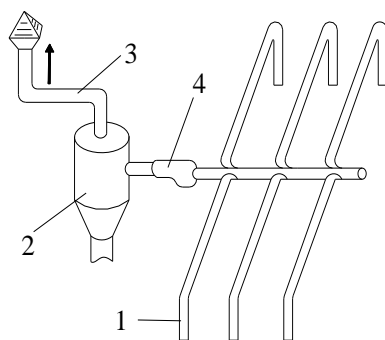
Принципова схема витяжної вентиляції.
